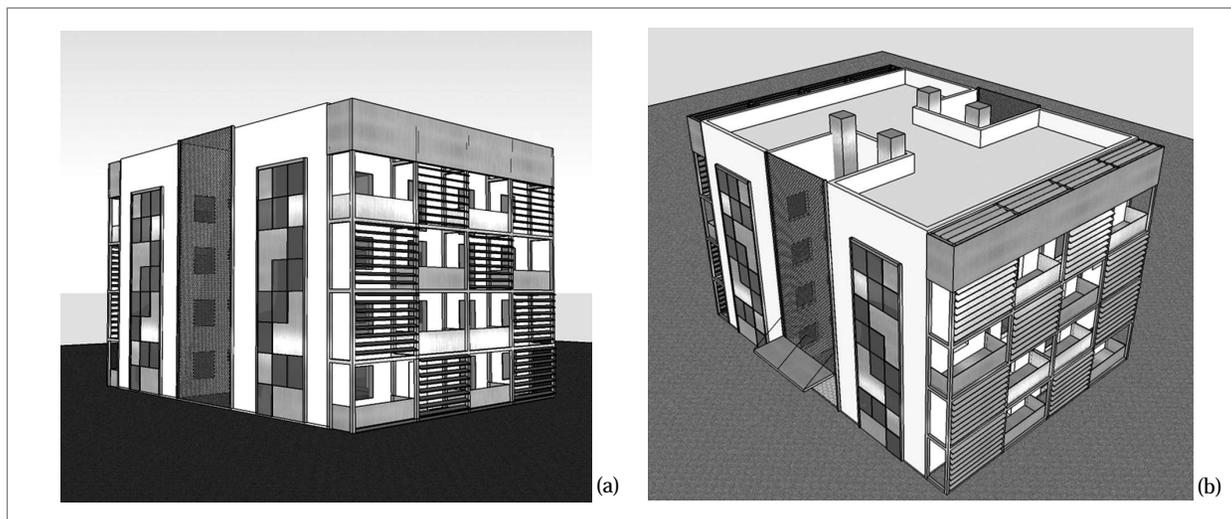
Propuestas de fachadas – Opción A – (a) y (b) – cubierta útil; balcones con posición distinta y brises móviles; paneles coloridos y echamiento metálico en el acceso principal.
